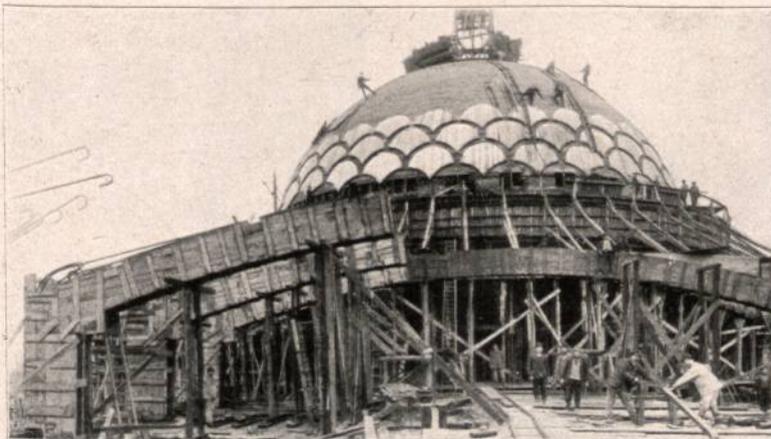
Kuppel der Betonhalle auf der Baufachausstellung in Leipzig 1913. (Rudolf Wölle mit Kell & Löser, Dresden.)
